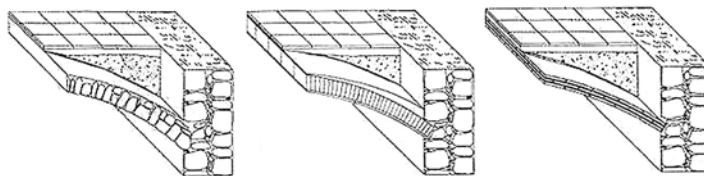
Secciones habituales de las bóvedas a base de piedra o ladrillo, colocado plano o a sardinel.
